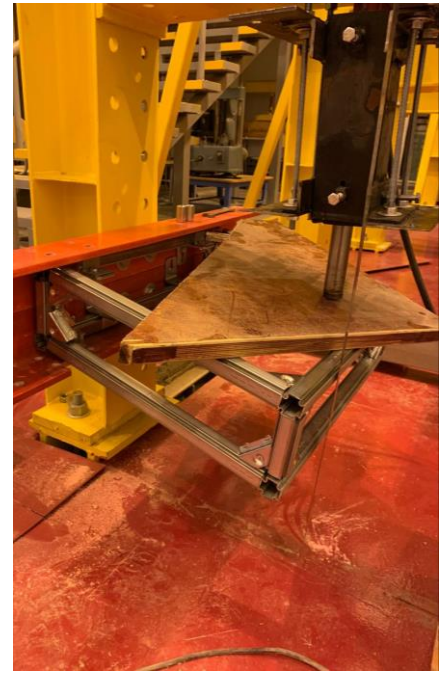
Загружение конструкции столешницы стгической нагрузкой
